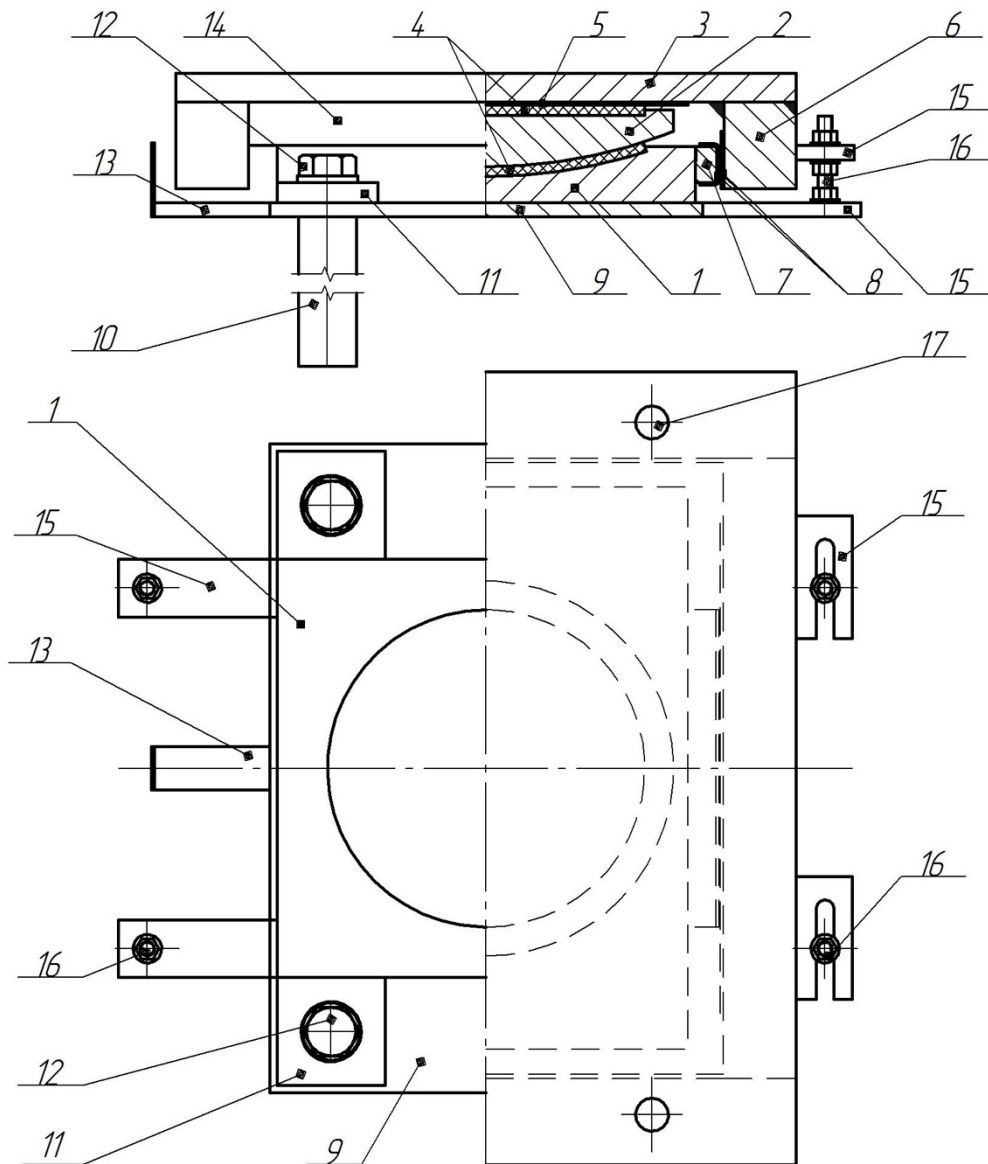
Конструкция линейно-подвижной опорной части ЛП СФОЧ.
